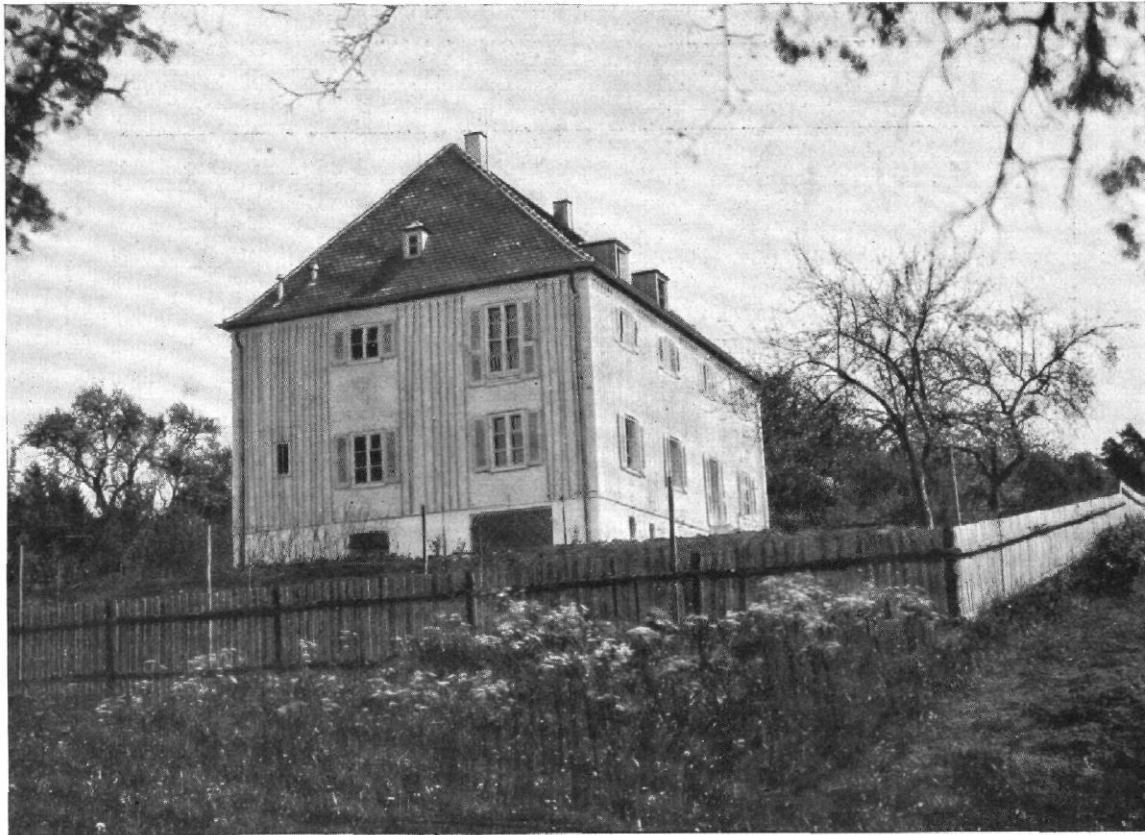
| Haus Dr. F. Wertheimer, Stuttgart | Fabriziertes Fachwerkhaus, Haustyp W | Blick von Südwest
